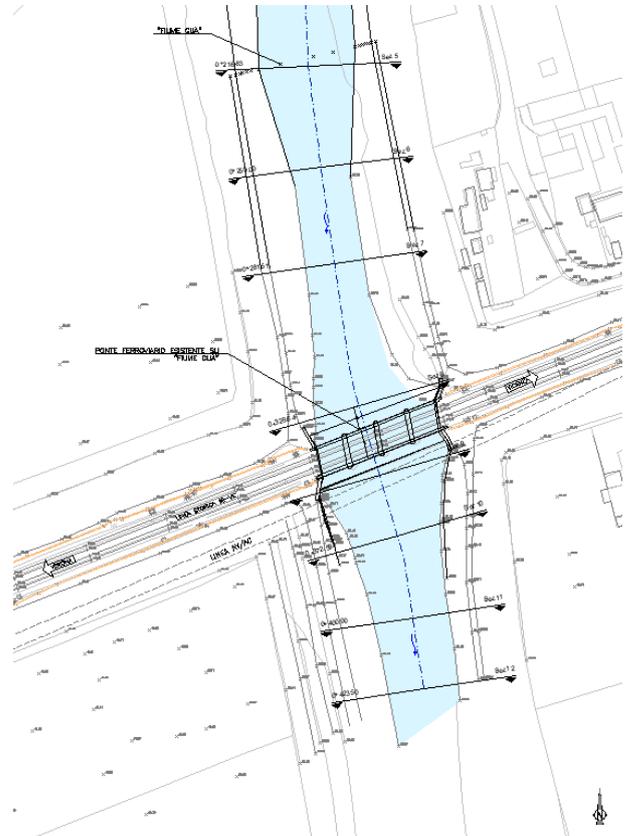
Estratto dalla tavola stato di fatto sistemazione Fiume Guà parte 2
